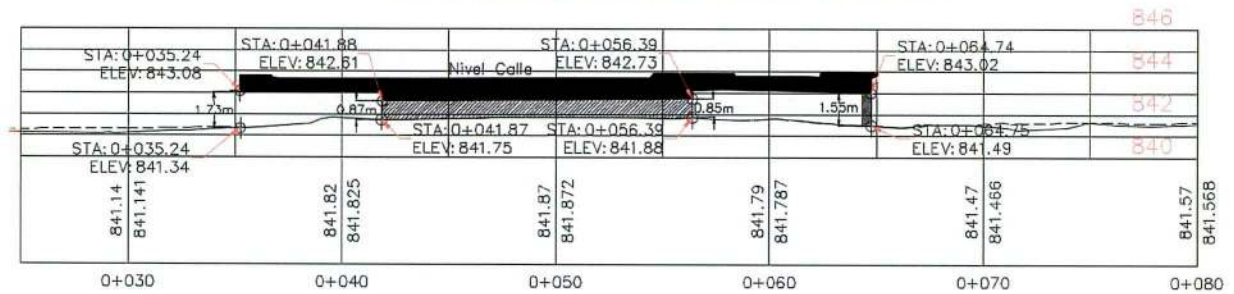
Perfil de la alcantarilla actual en la Quebrada Rodríguez
